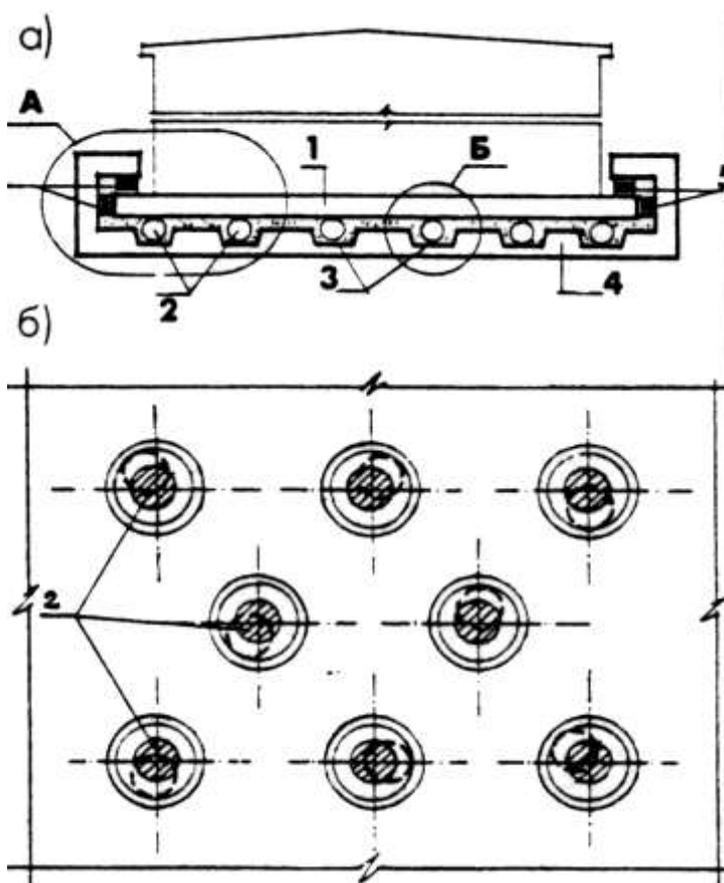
Поперечный разрез сейсмостойкого фундамента до осадки здания (а), возможное положение опор при землетрясении (б)
